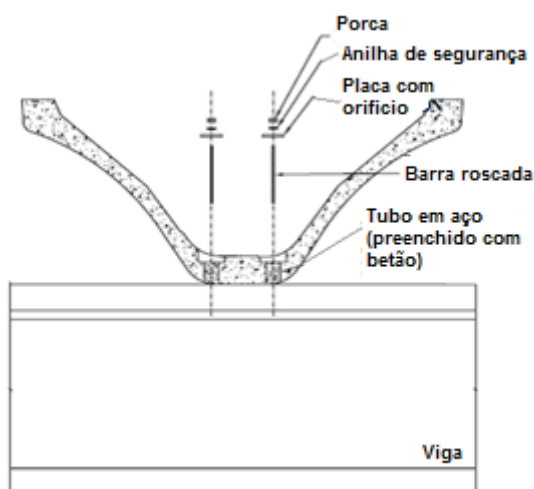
Intervenção para a ligação entre elementos de casca e viga – Ordem 2 – Tipo 14 [16]
